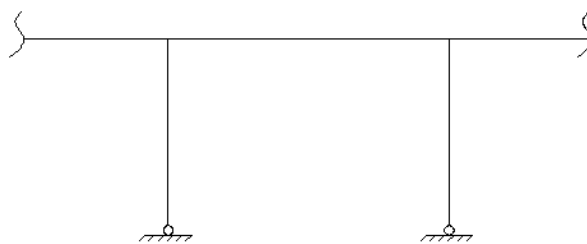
Схема шарнірного кріплення колон до фундаментів.
